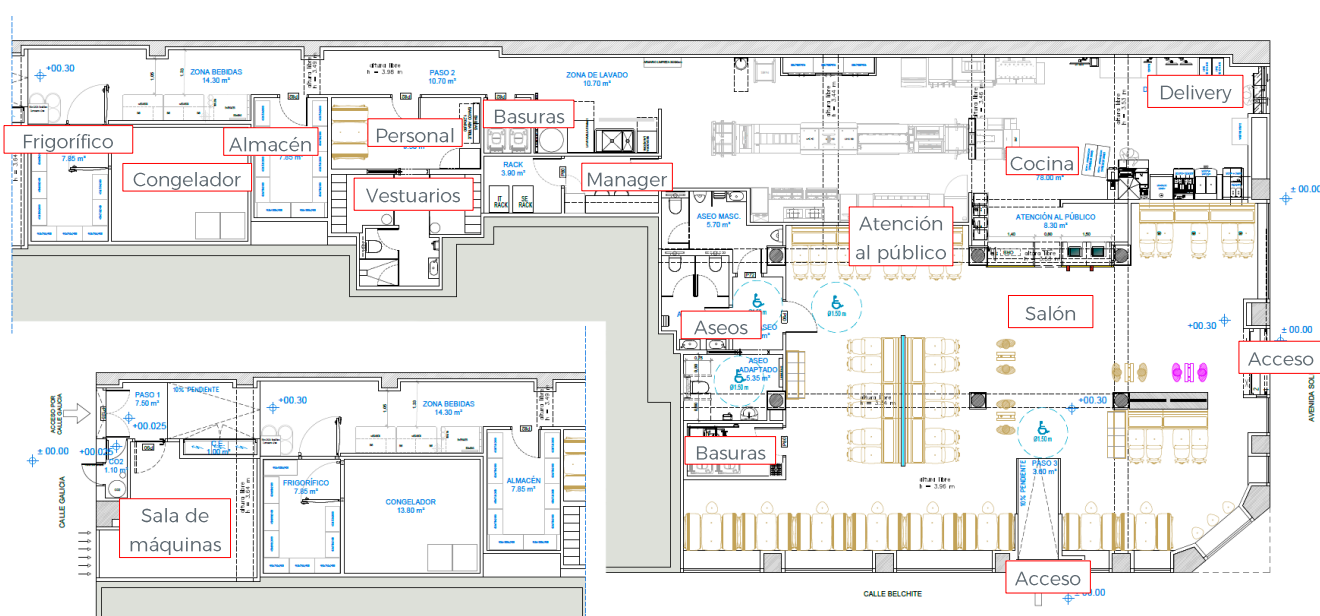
Planta baja Local - Calle Belchite 2, Logroño.
